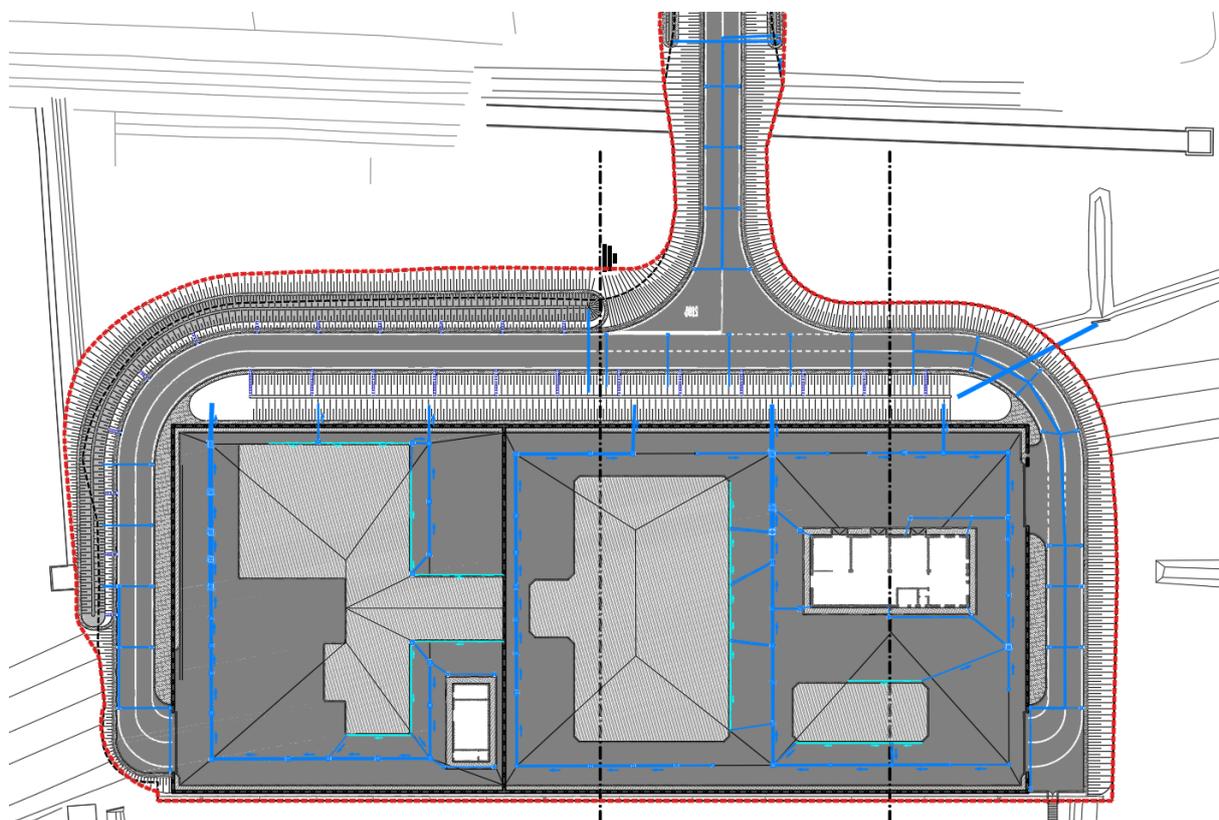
Estratto planimetrico dello stato di progetto – Individuazione dell’area oggetto di intervento con polilinea tratteggiata rossa.
